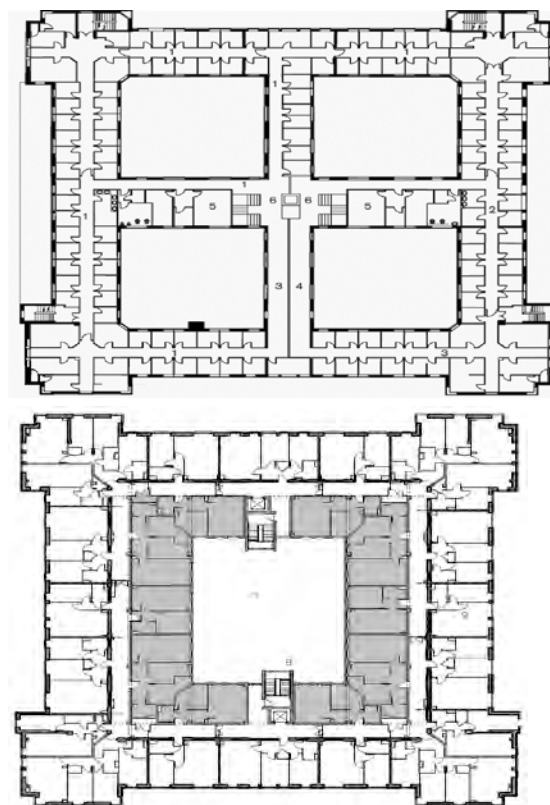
План типового этажа здания «Greenhouse» в Лондоне до и после перестройки
